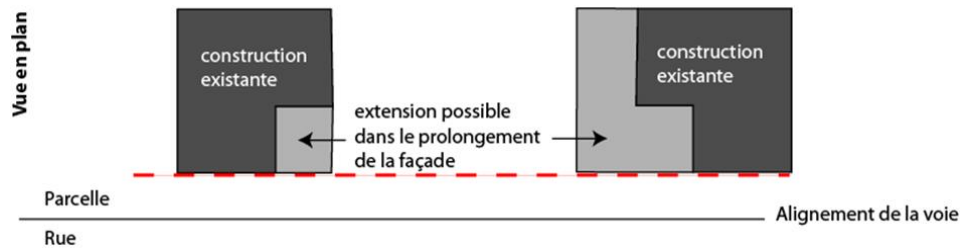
Implantation dans le prolongement de la façade pour les extensions des constructions en zone Ua
